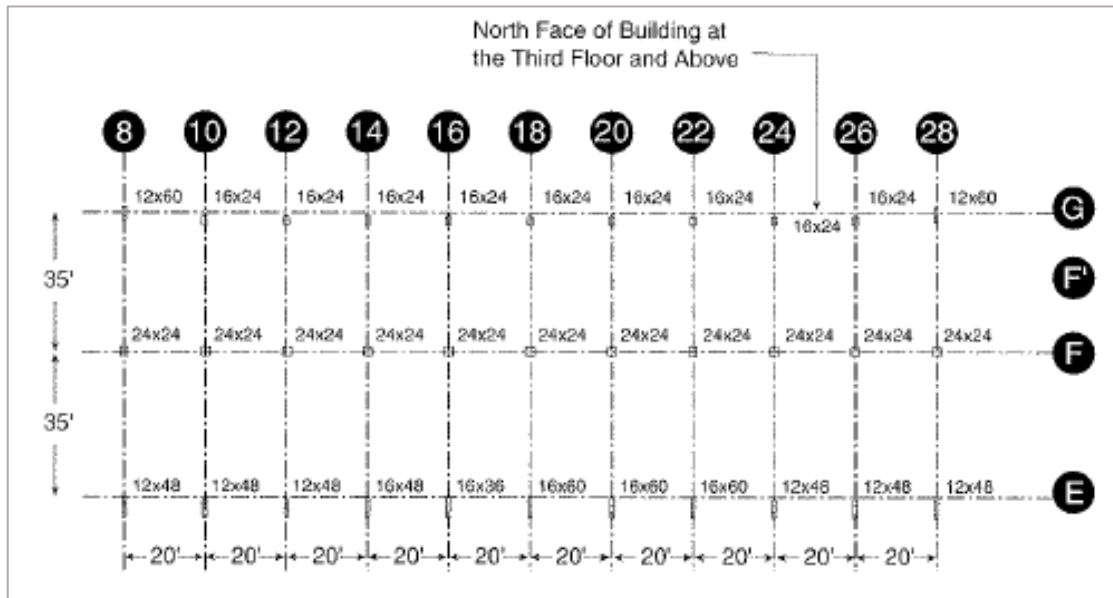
Plano en planta del Alfred P. Murrah (3ª - 9ª planta). [22]
